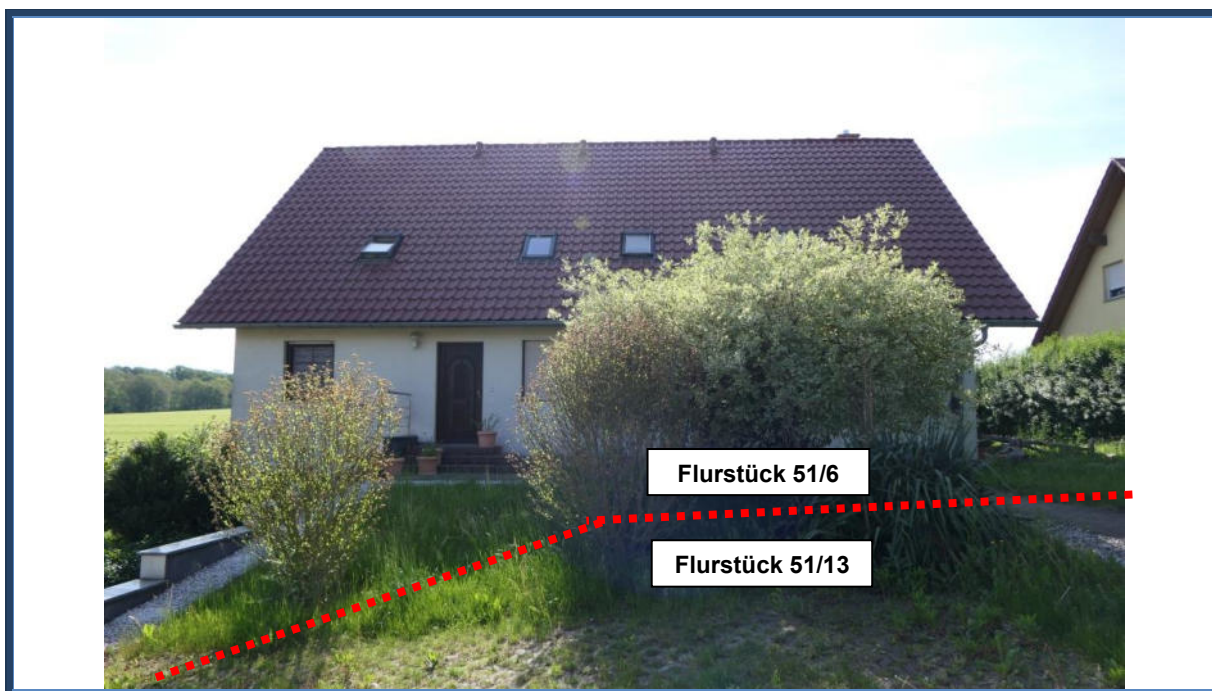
Straßenansicht (West-Ansicht); Eingangs-/Einfahrtsbereich; links die Garagenzufahrt; Außenanlagen tlw. auf dem vorgelagerten Fremdgrundstück (Flurstück 51/13); umliegende Bebauung
